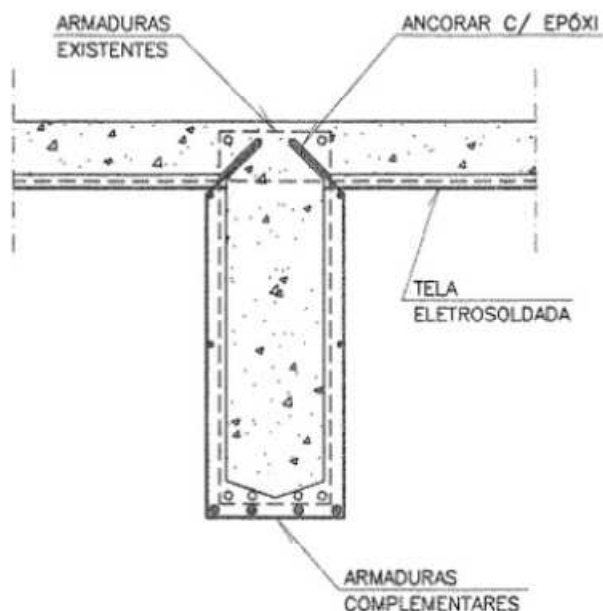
Detalhe de projeto para reforço de armadura e colocação de tela.
